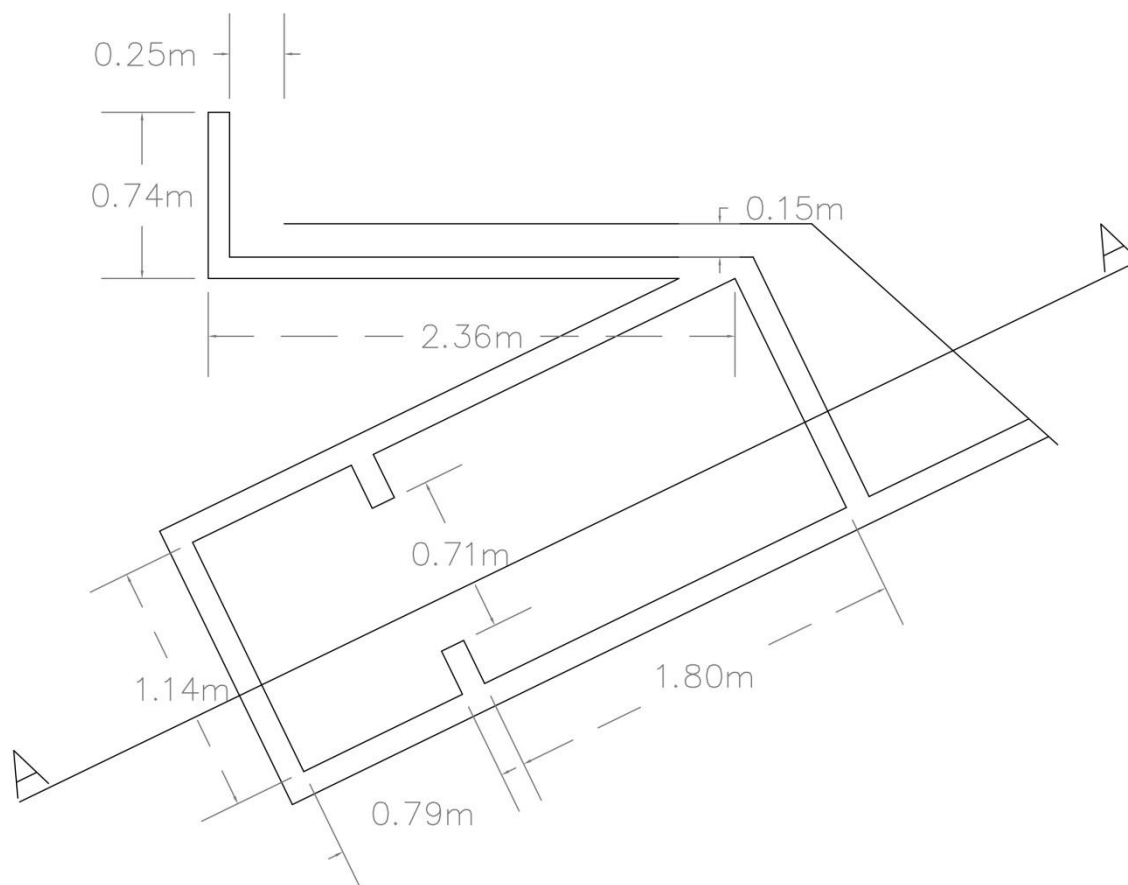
Dimensiones de la cámara de captación y vertedero de rebose en Planta.
